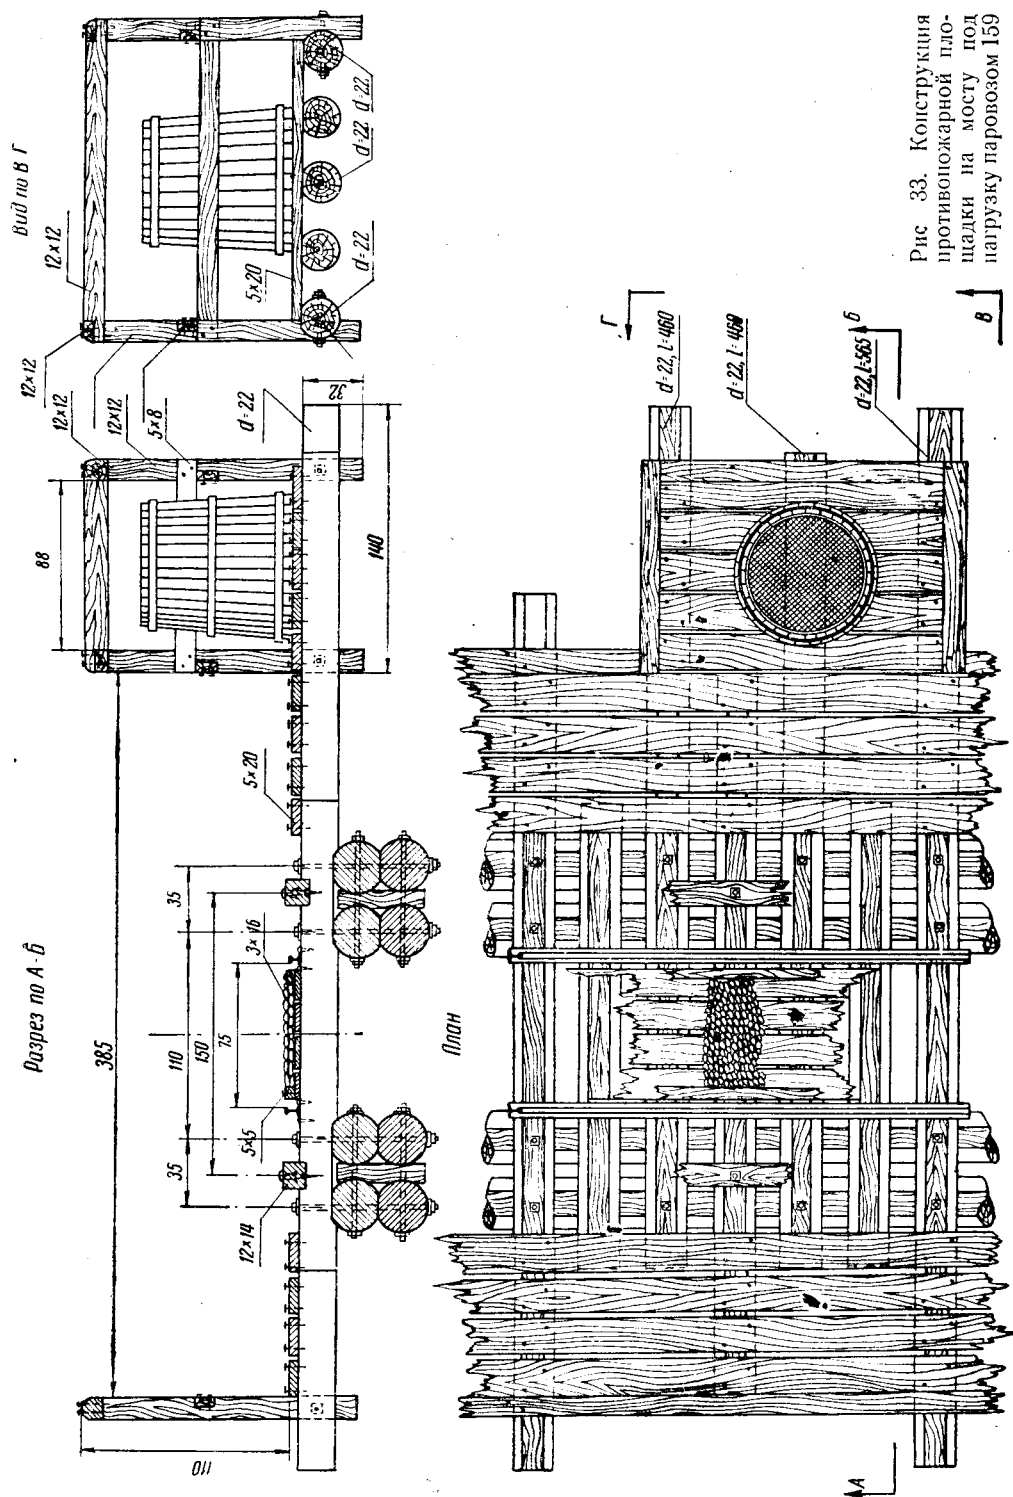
Конструкция противопожарной площадки на мосту под нагрузку паровозом 159
